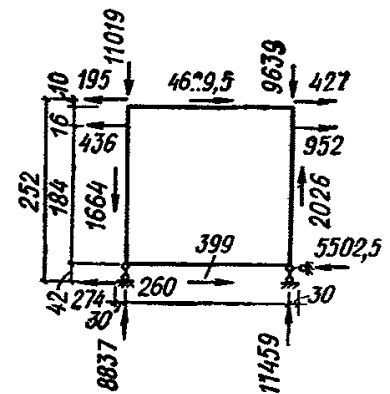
Расчетная схема панели 1-го этажа 2-го столба
